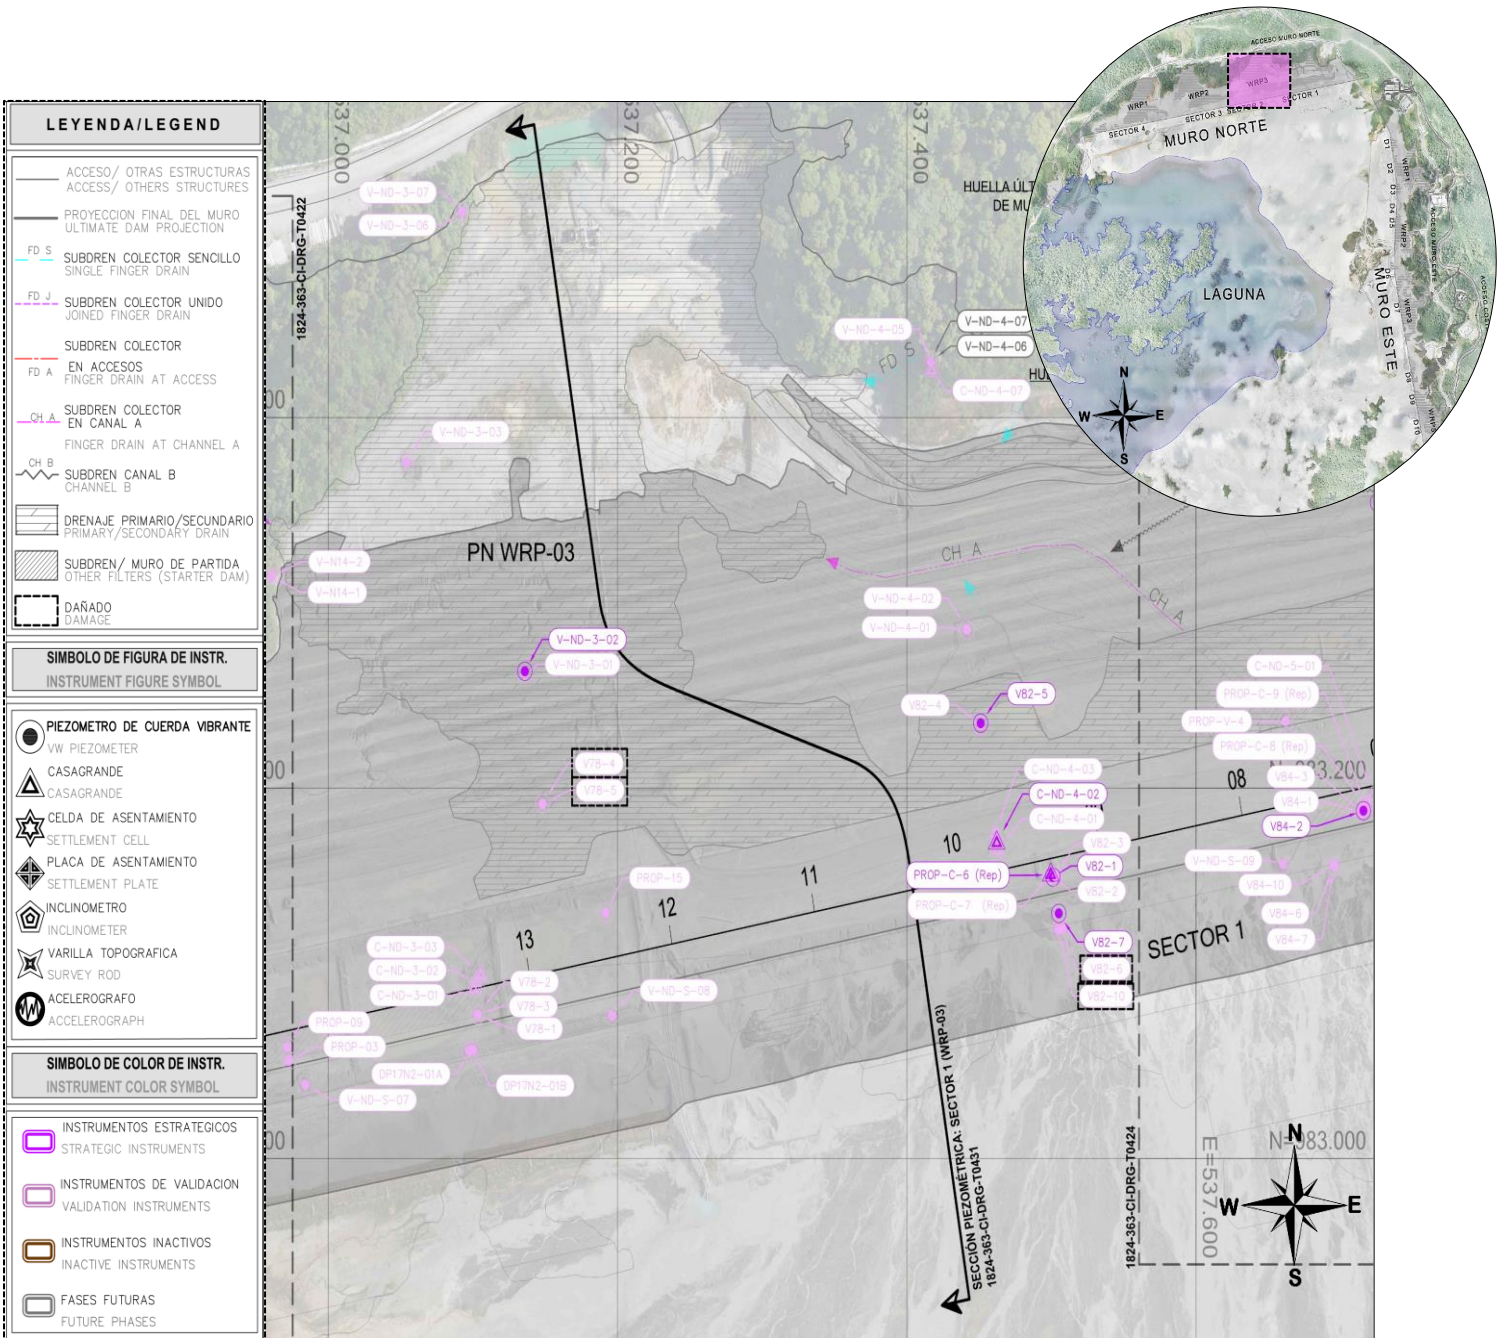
Vista de Planta en Muro Norte Sector 1 - WRP3 con Piezómetros
